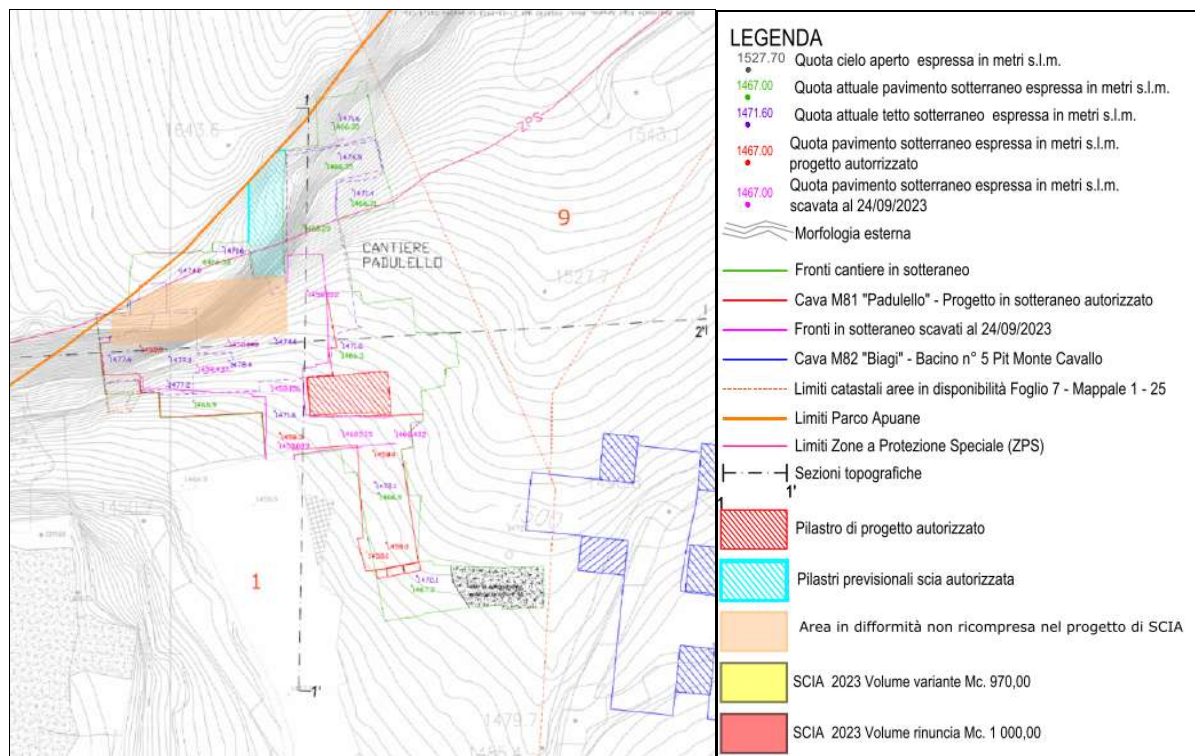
Progetto autorizzato e stato attuale cava al Settembre 2023 (estratto Tav 1_P_2023)
